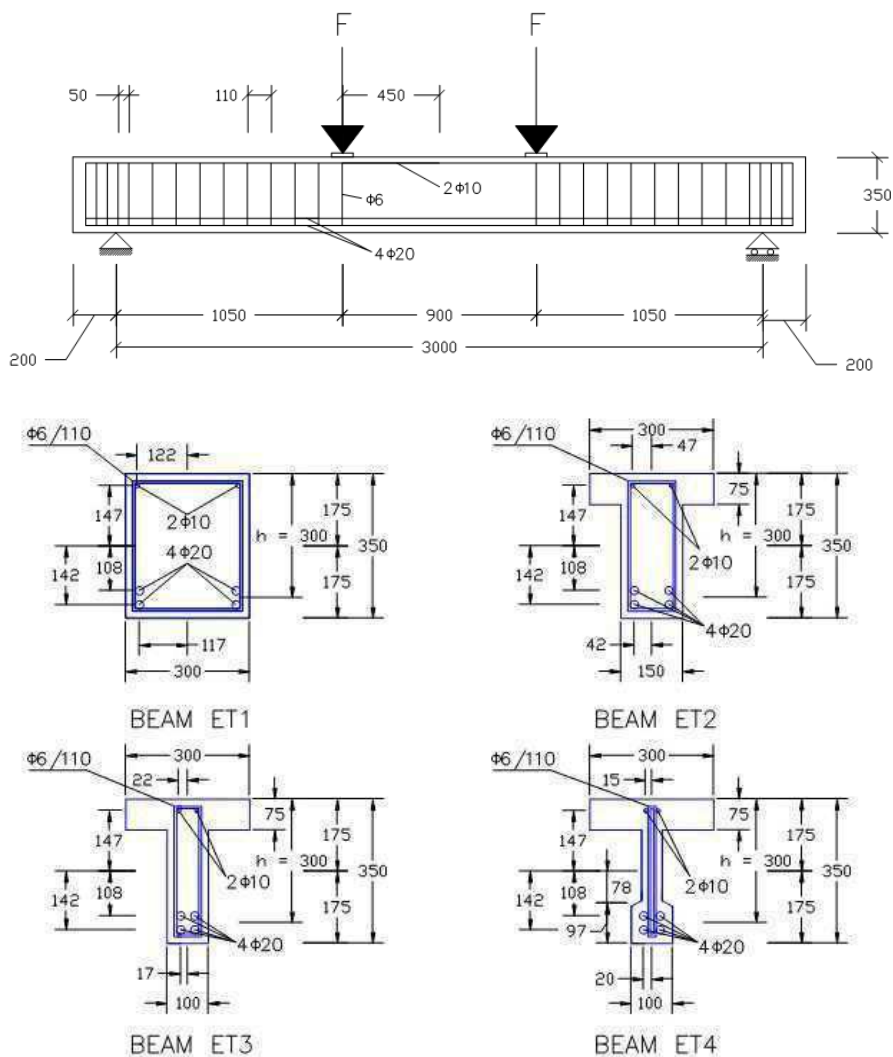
caractéristiques géométriques et détails de ferrailage des essais à l'effort tranchant. Poutres Stuttgart [101].
